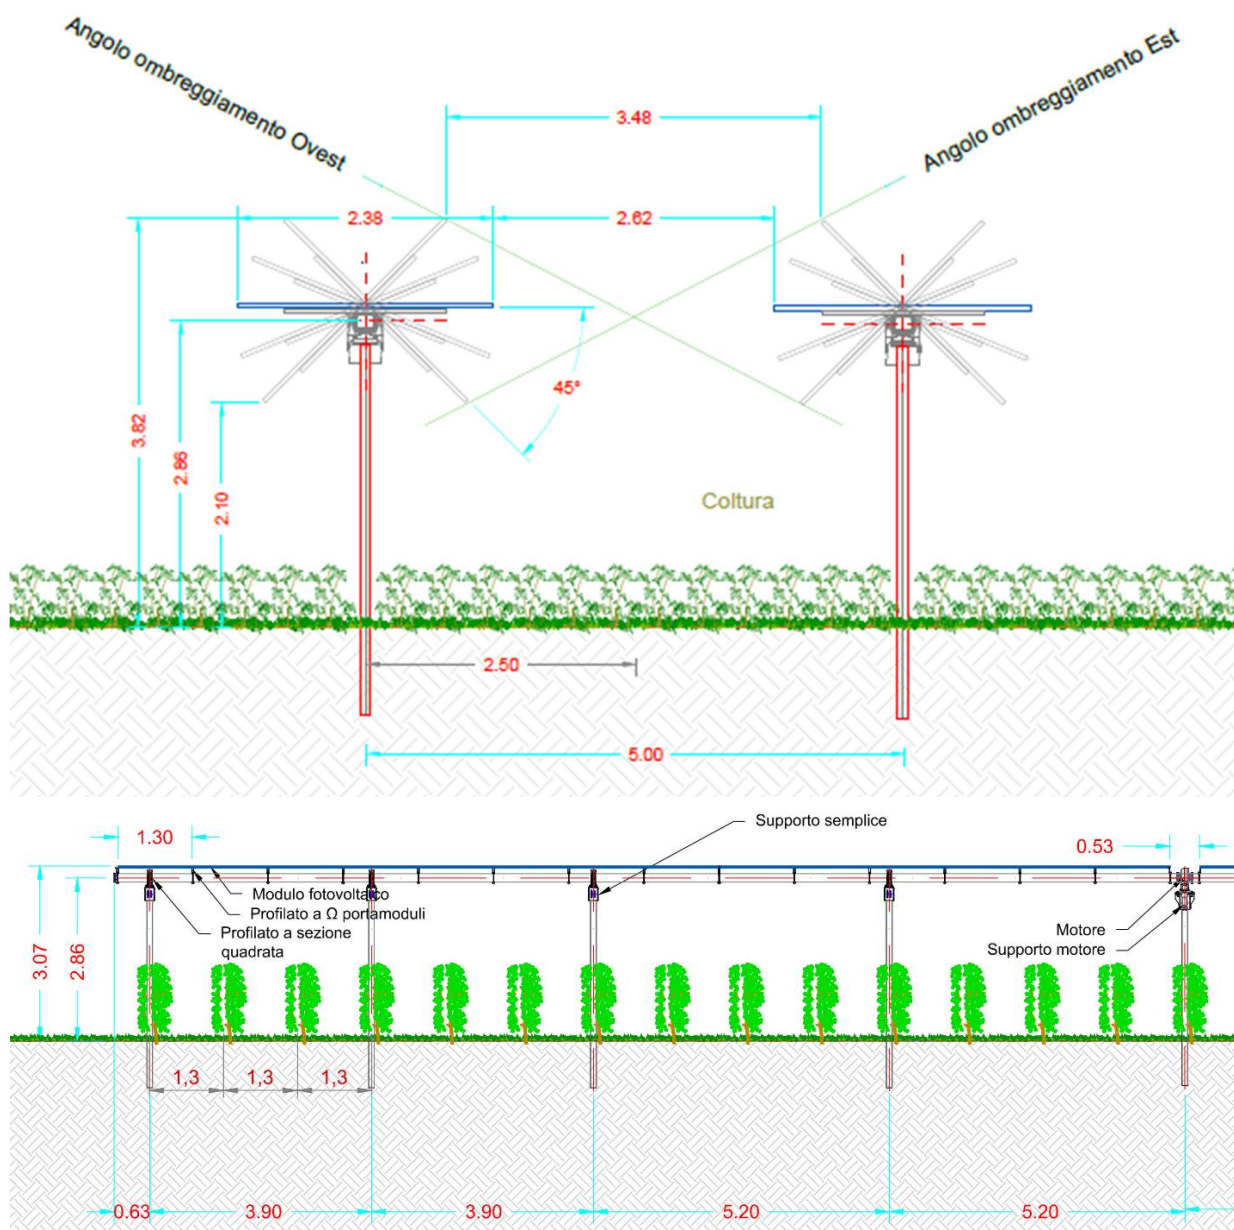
Sezione trasversale e longitudinale tipologica struttura Tracker
